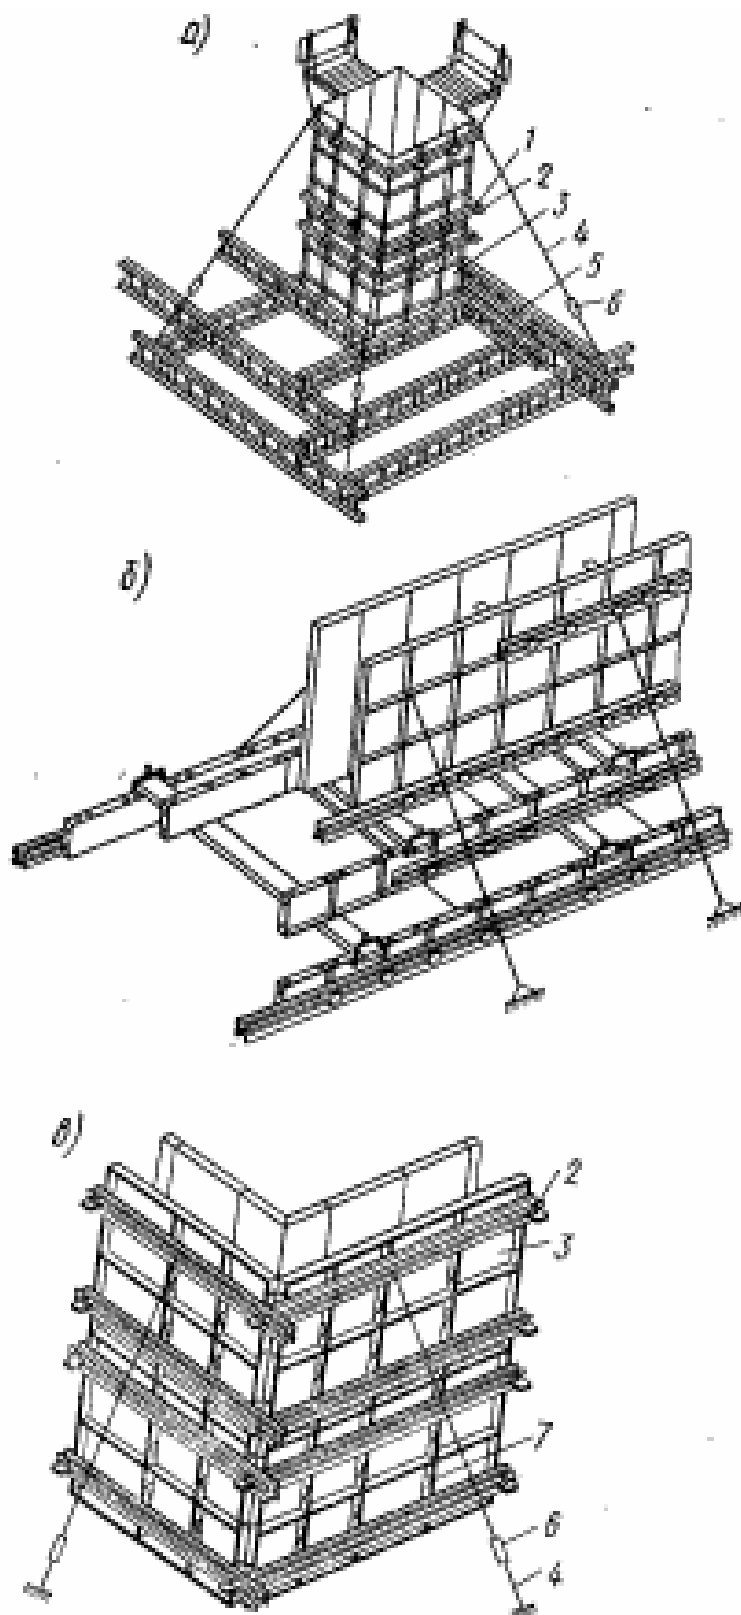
Общий вид смонтированной опалубки: *a* – ступенчатого фундамента; *б* – ленточного фундамента; *в* – угла стен; 1 – клин для крепления схваток; 2 – угловое соединение схваток; 3 – щит опалубки; 4 – расчалка; 5 – ферма; 6 – фаркопф; 7 – пружинная скоба
